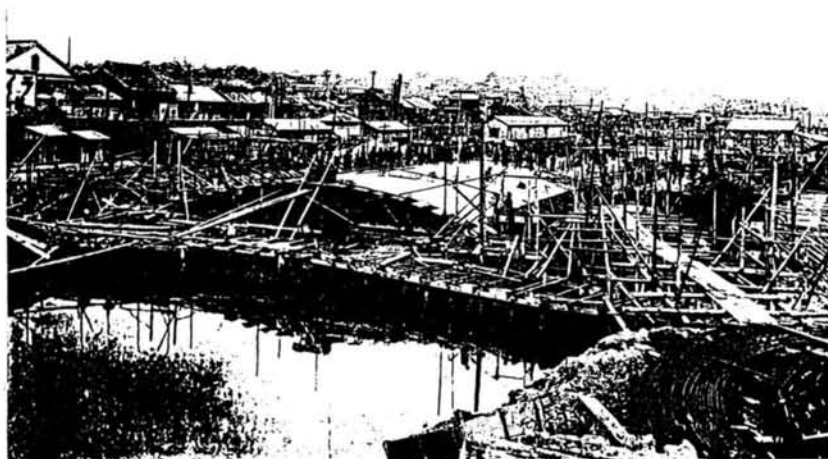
横浜市吉田橋、施工時状況（「鉄筋コンクリート案内」明治45年）
